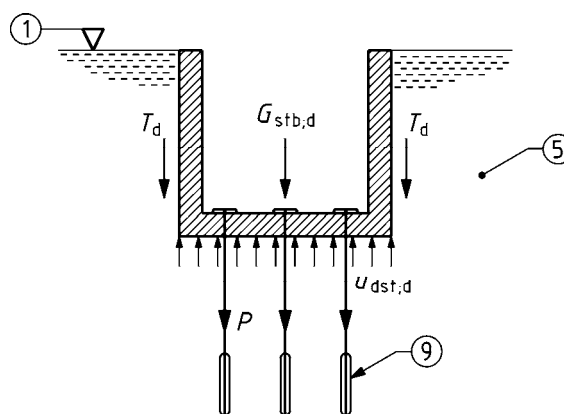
Exemplos de situações em que o levantamento global pode ser crítico (continua)
